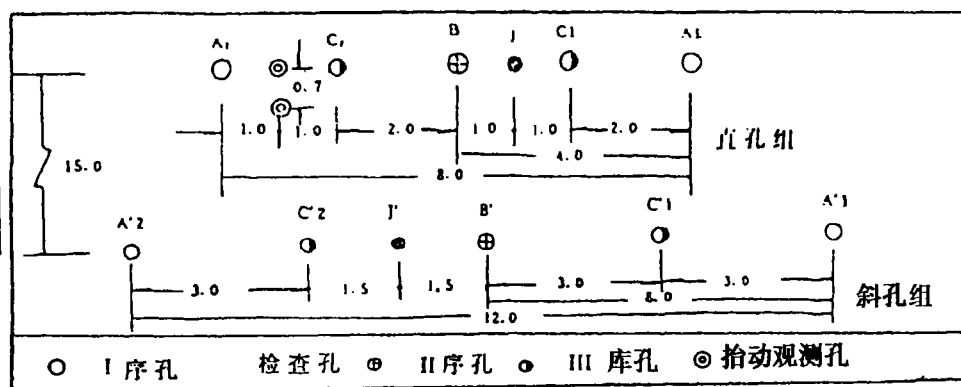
直、斜孔组灌浆试验钻孔平面布置示意图(单位:m)
